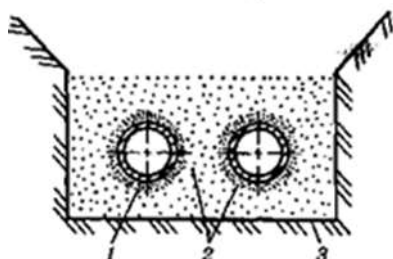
, Разрез бесканального теплопровода в самоспекающемся асфальтите
